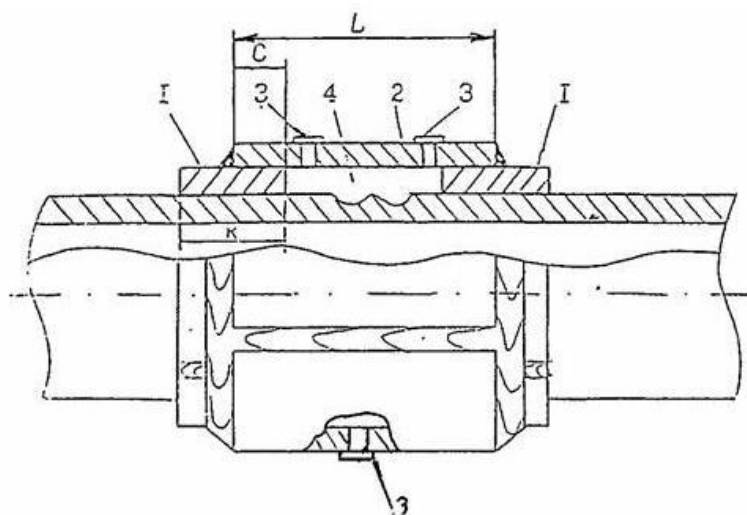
Сварная муфта 1 - кольцо муфты; 2 - наружная муфта; 3 - резьбовое отверстие для заливки и контроля заполнения муфты эпоксидной смолой; 4 - эпоксидная смола
